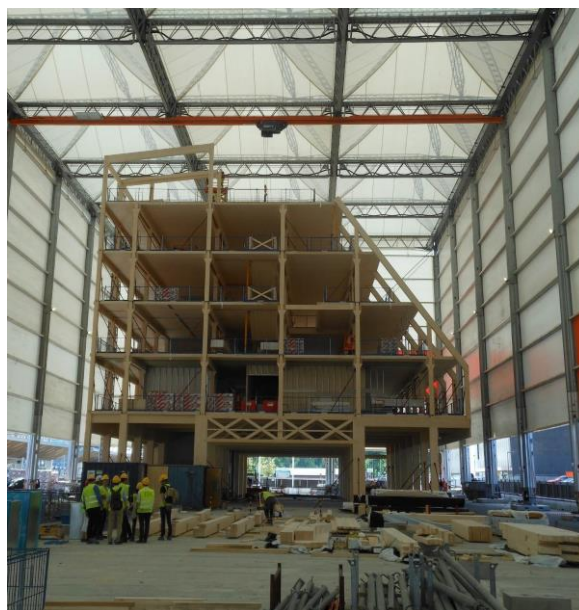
Exemple de protection générale de type chapiteau (Source LERMAB)
